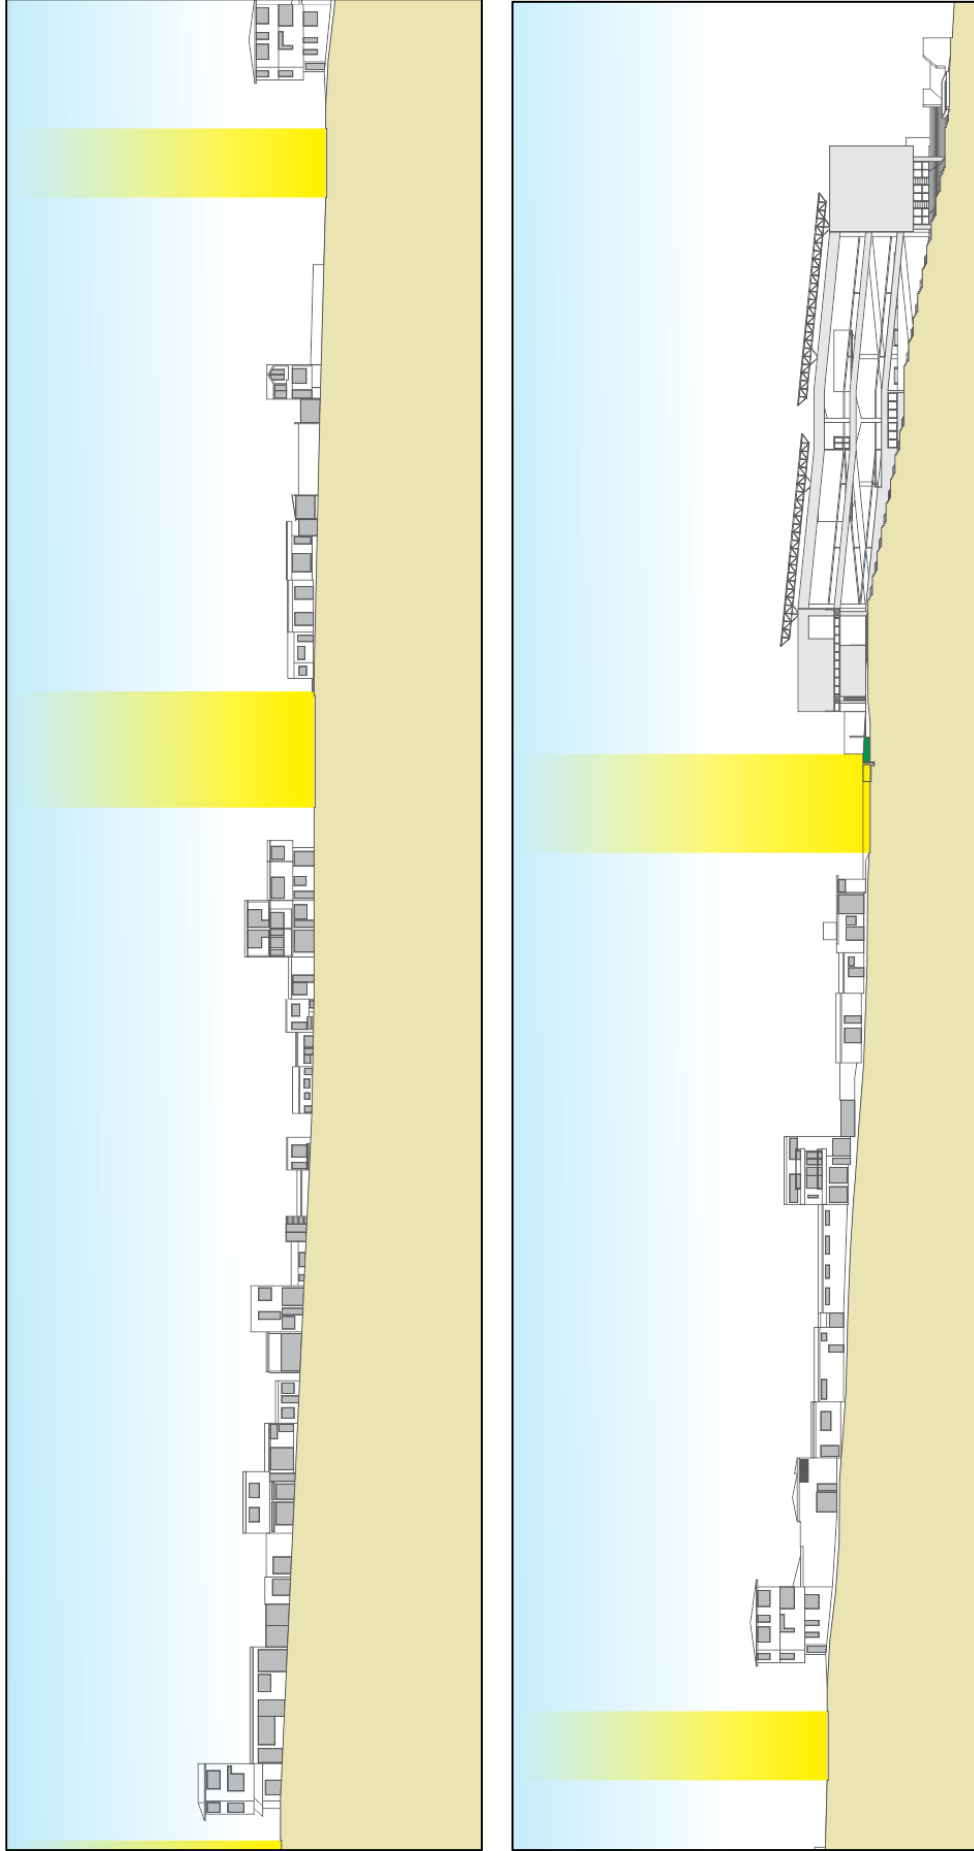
Arriba jr. Amorarca cuadras 01 y 02; abajo cudra 03 y sección del acceso propuesto descendiendo conjuntamente con el edificio del planteamiento.
